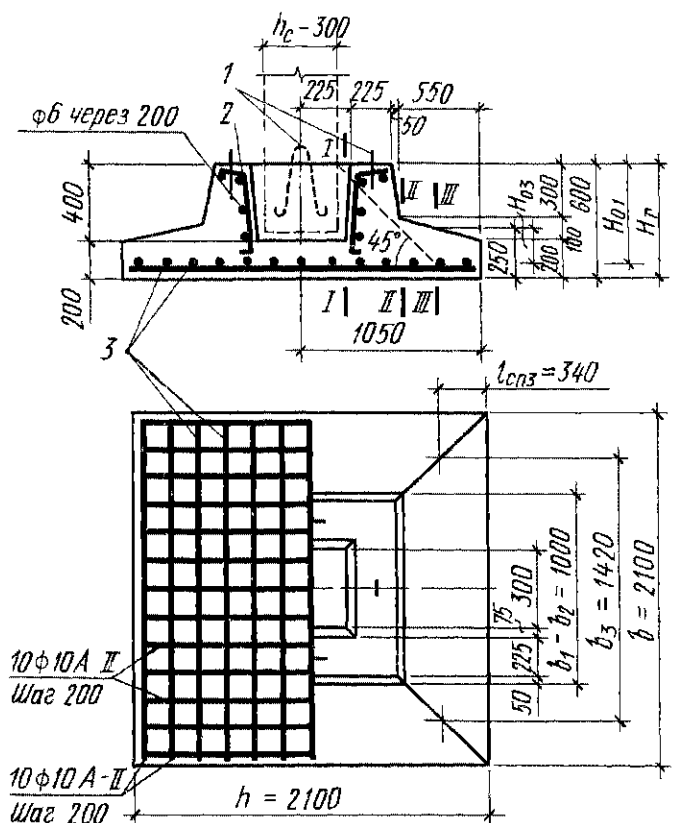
Армирование отдельного фундамента 1 — монтажные петли, 2 — конструктивная арматура, 3 — рабочая арматура
